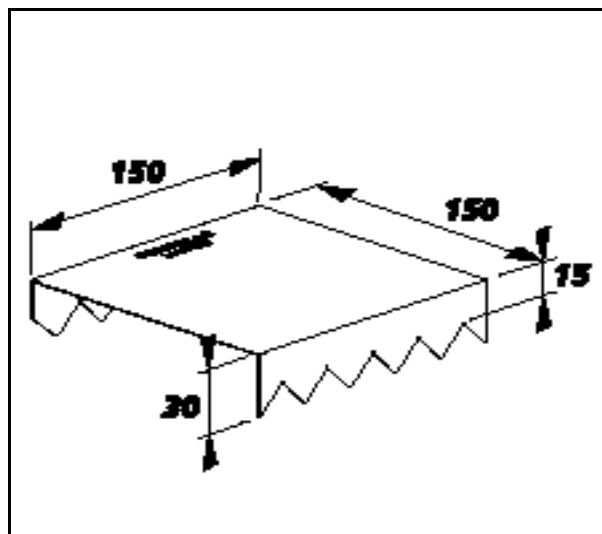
Figure de la plaquette crantée Pittsburgh Corning France (dimensions en mm)
